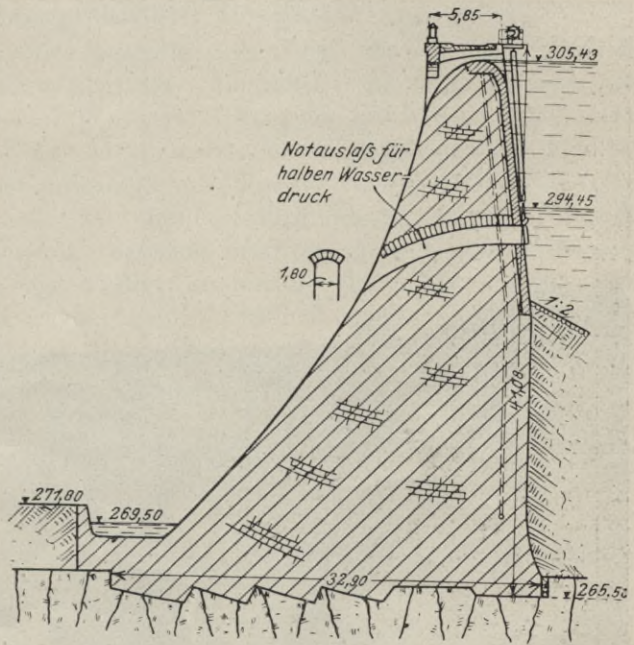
Querschnitt der Ennepe-Talsperre mit Mauerüberlauf, Hochwasserentlastung in $\frac{3}{4}$ Stauhöhe und Sturzbett.
